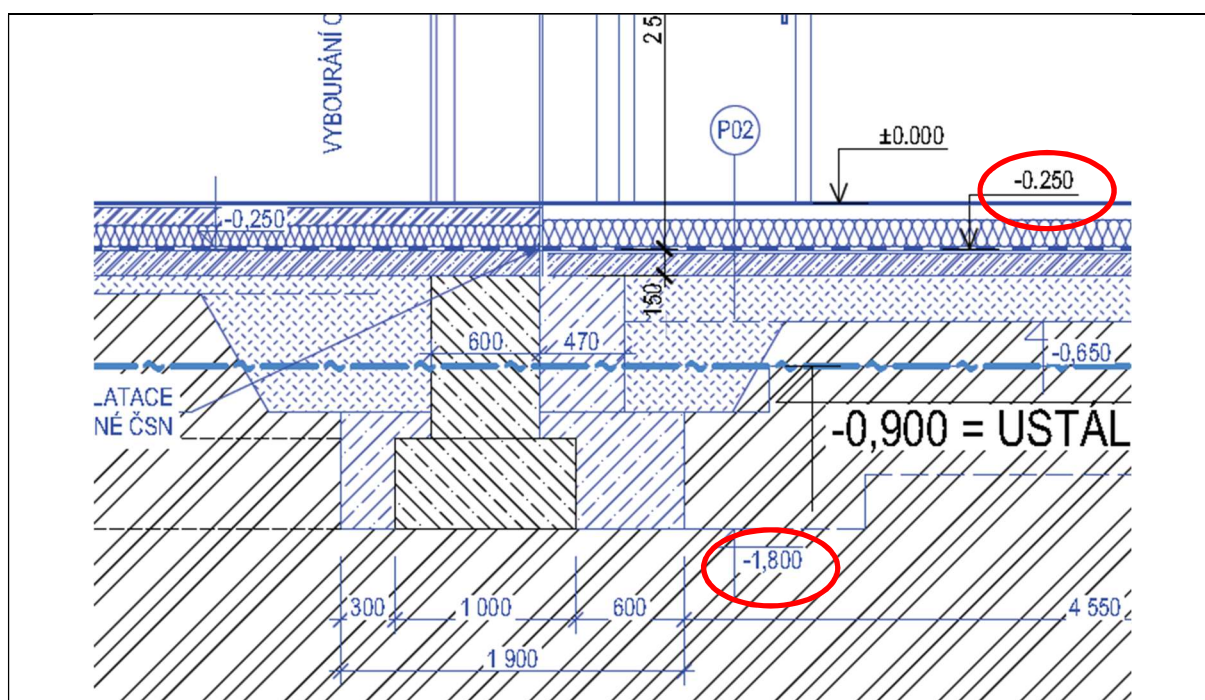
Technická zpráva části D.ST, odstavec 4.2., str. 10 [3]
